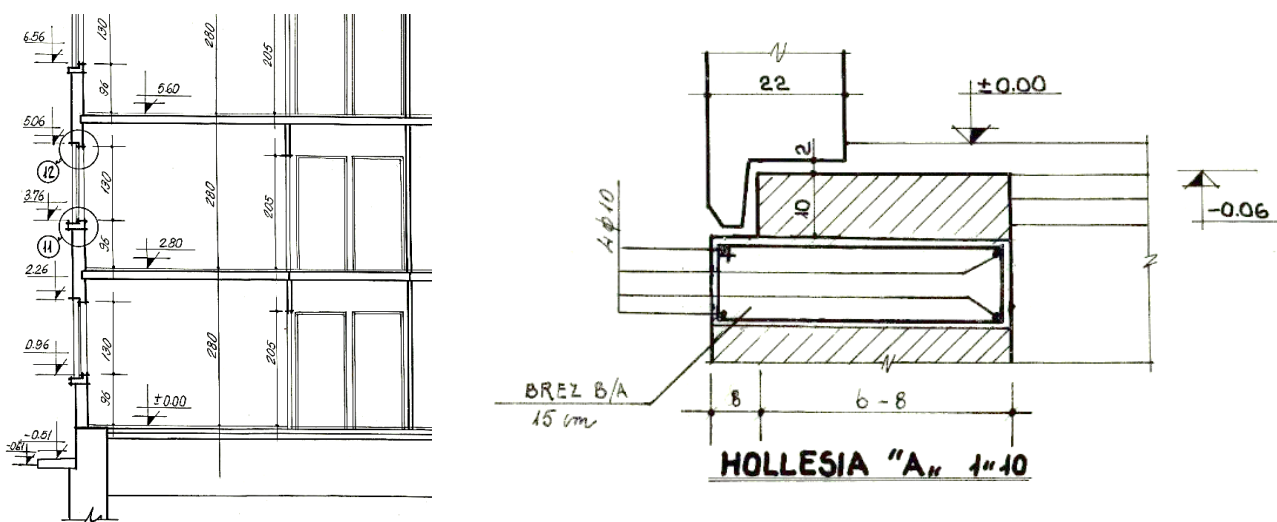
Sezione del Modulo 1, dettaglio del supporto dei pannelli armati perimetrali sulle travi delle fondazioni, I.S.P. n. 1, 1979 [AQTN]
